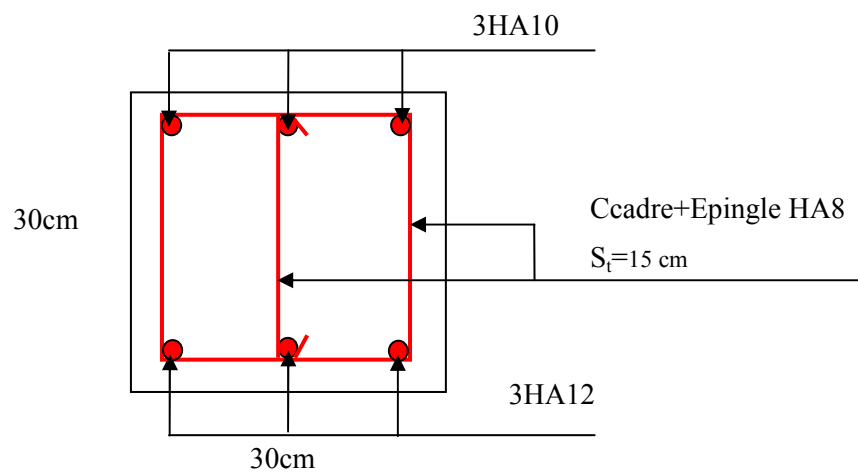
schéma de ferrailage de la poutre de chaînage.
